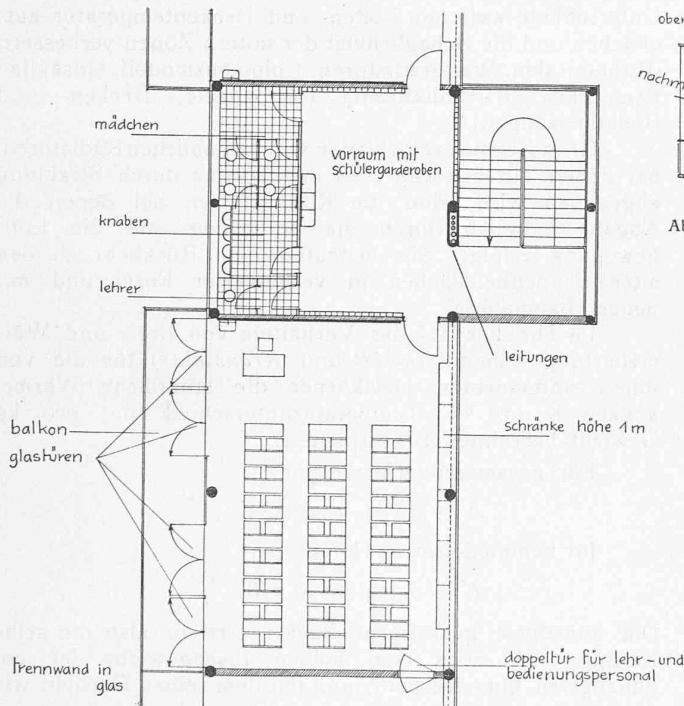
Entwurf Freiluftschule A. Roth, Grundriss des Systems 1 : 200. Beispiel für eine bauliche Anordnung, die sowohl grundrisslich als auch betriebsmässig nur durch die Deckenheizung ermöglicht wird.
